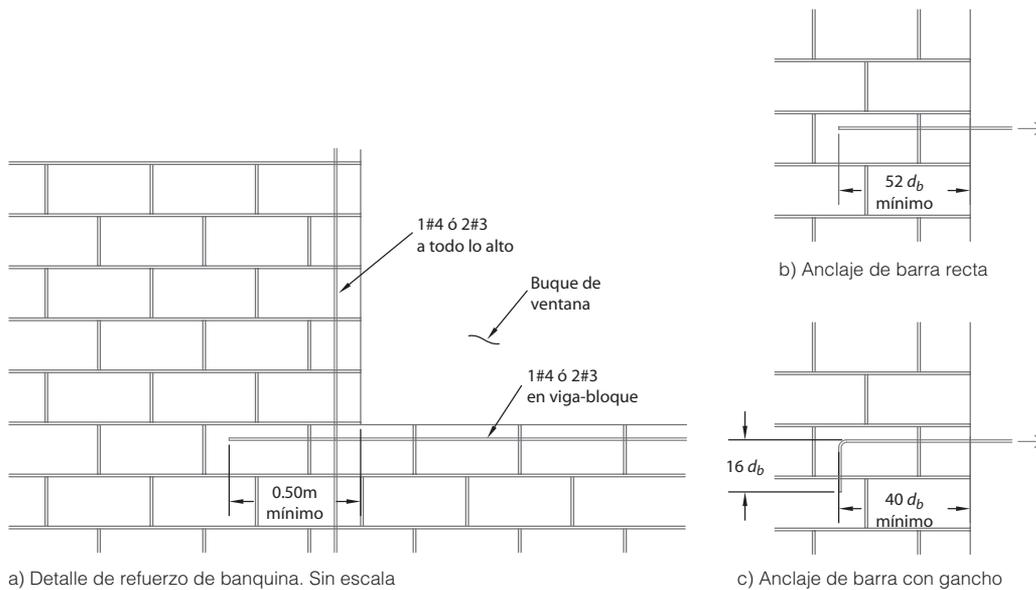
Detalles de anclaje de refuerzo en viga bloque.
